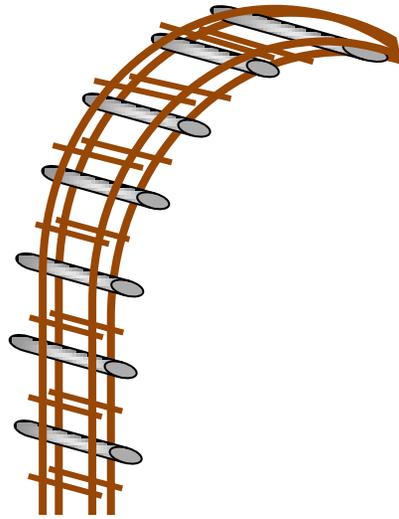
Vista tridimensional de la estructura armada del zuncho de hormigón
